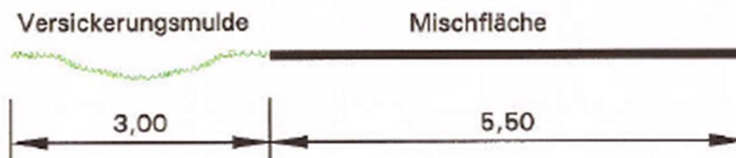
Auszug Bebauungsplan Nr. 12 Teil 1
